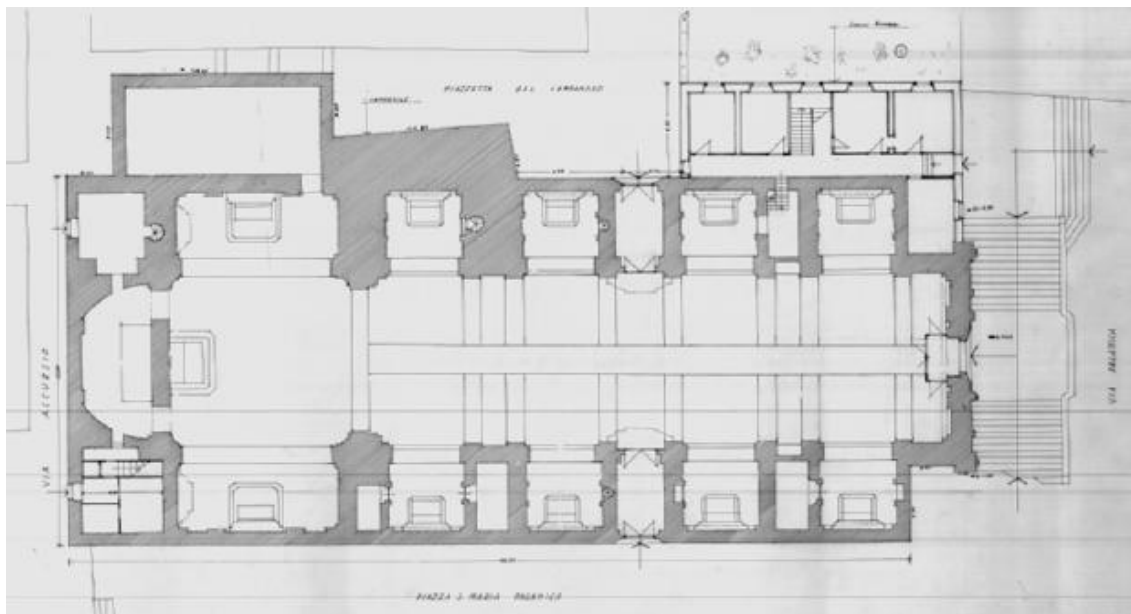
Pianta della chiesa di Santa Maria di Paganica
